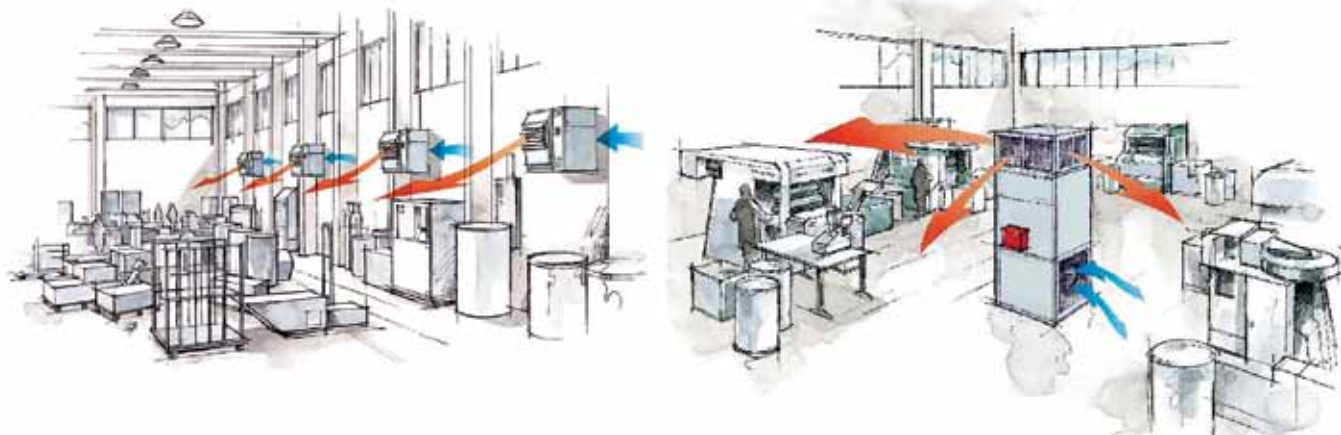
Газоздушное отопление производственных помещений: варианты конструктивных решений (слева – настенное, справа – напольное)
